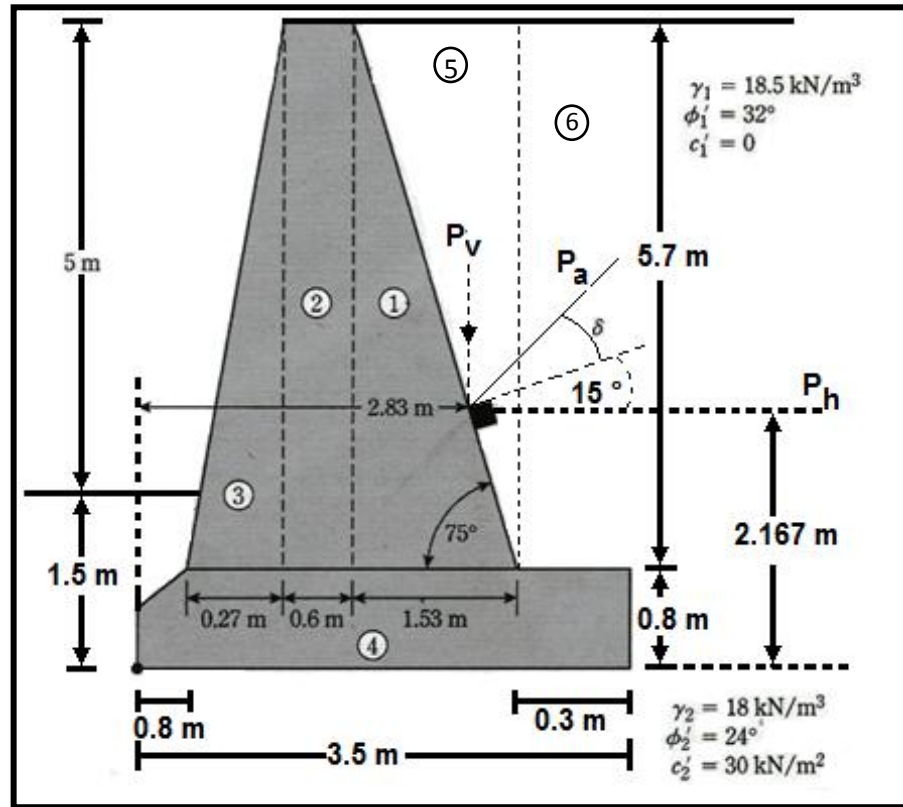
Muro de contención a gravedad (fuera de escala)
